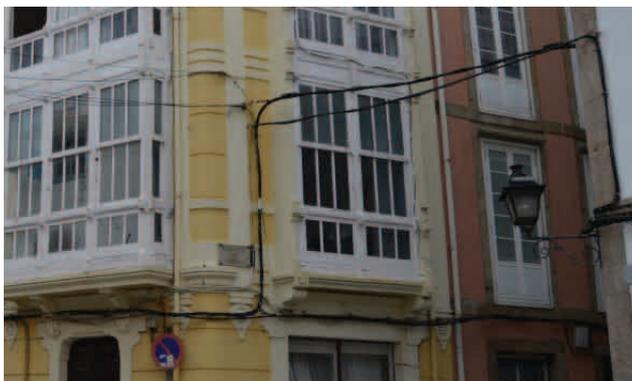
Cableado colgado entre fachadas (fuente: propia, c/Herrerías)
